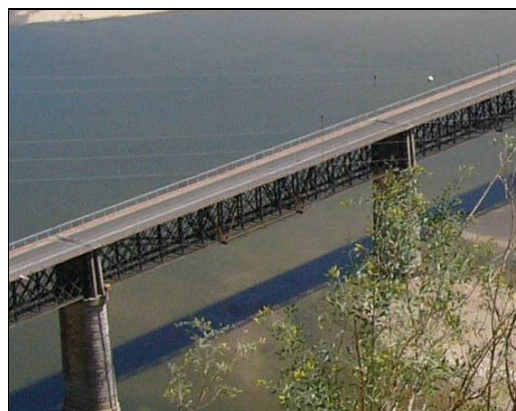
Exemplo de uma ponte em viga treliçada: Ponte Luís I Santarém
